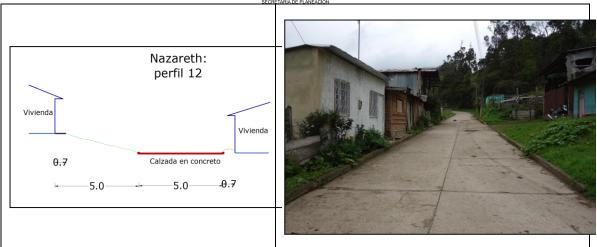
Perfil vial 12, SDP 2013. Corresponde a la vía que lleva a Betania, se encuentra acabada en concreto, de reciente cobertura
